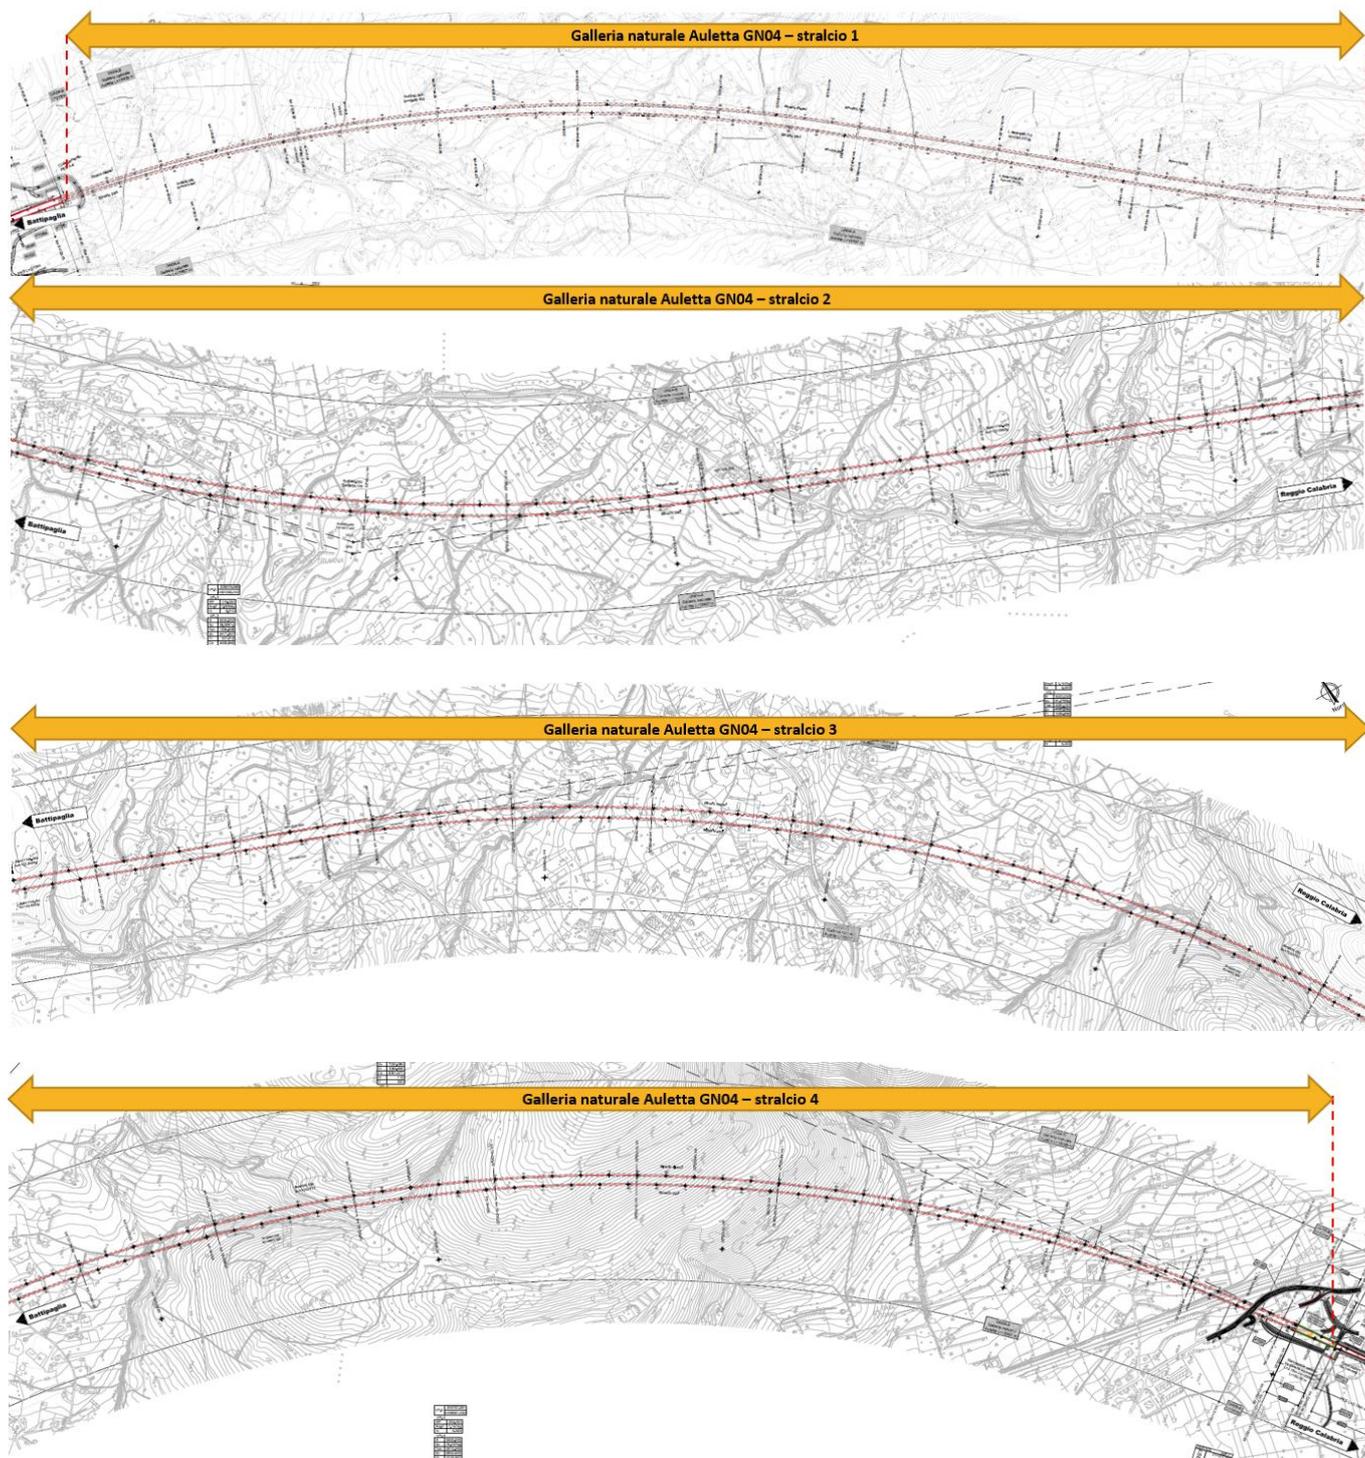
Planimetria galleria naturale GN04 da km 6+188 a km 21+927 BP
